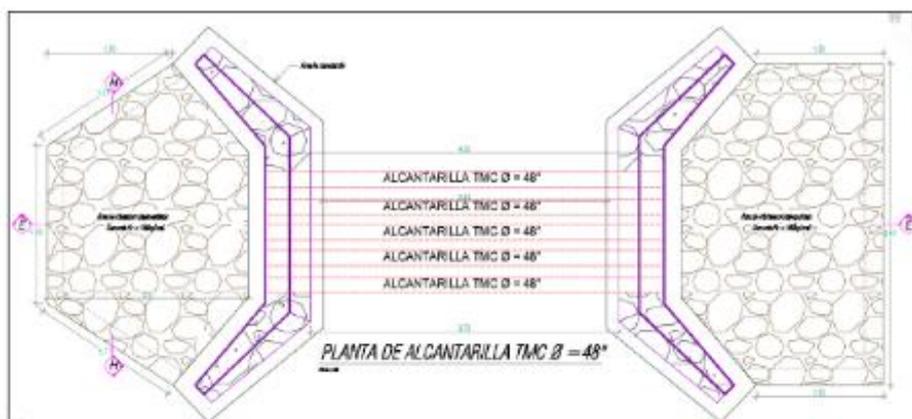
PLANO EN PLANTA DEL MODELO PROPUESTO
